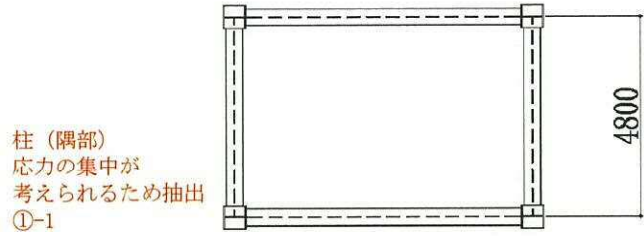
非常用ガス処理系配管支持架構の概略平面図 (EL. 14.2 m)
